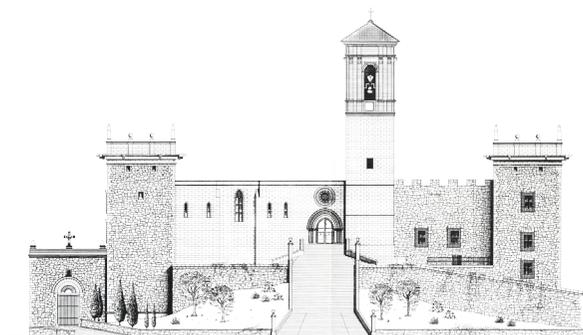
Fachada norte restaurada del Monasterio de El Puig
